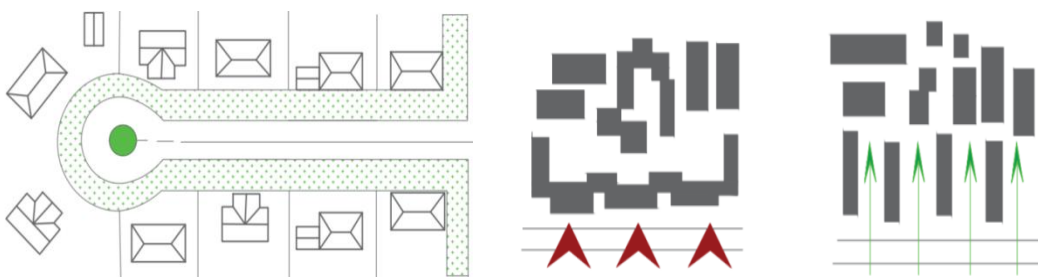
Barreiras contínuas (reflexões x fachadas) / Barreira em um dos lados (campo livre).
